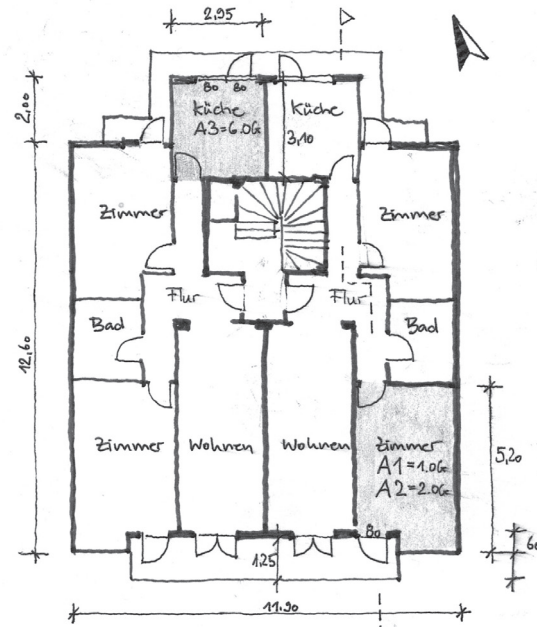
Beispielgebäude A, Grundriss Geschosse 2-6, Lage der Räume A1, A2 und A3 (eigene Skizze)
